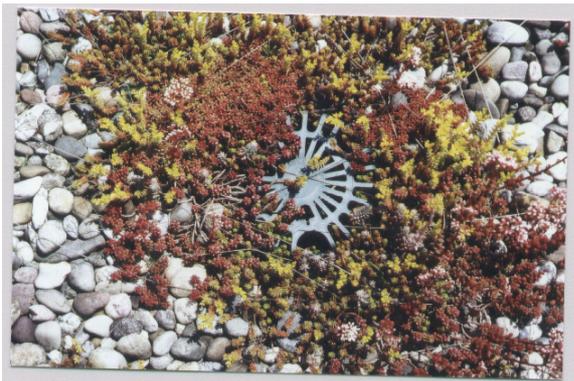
Entwässerungseinrichtungen müssen zugänglich ...
